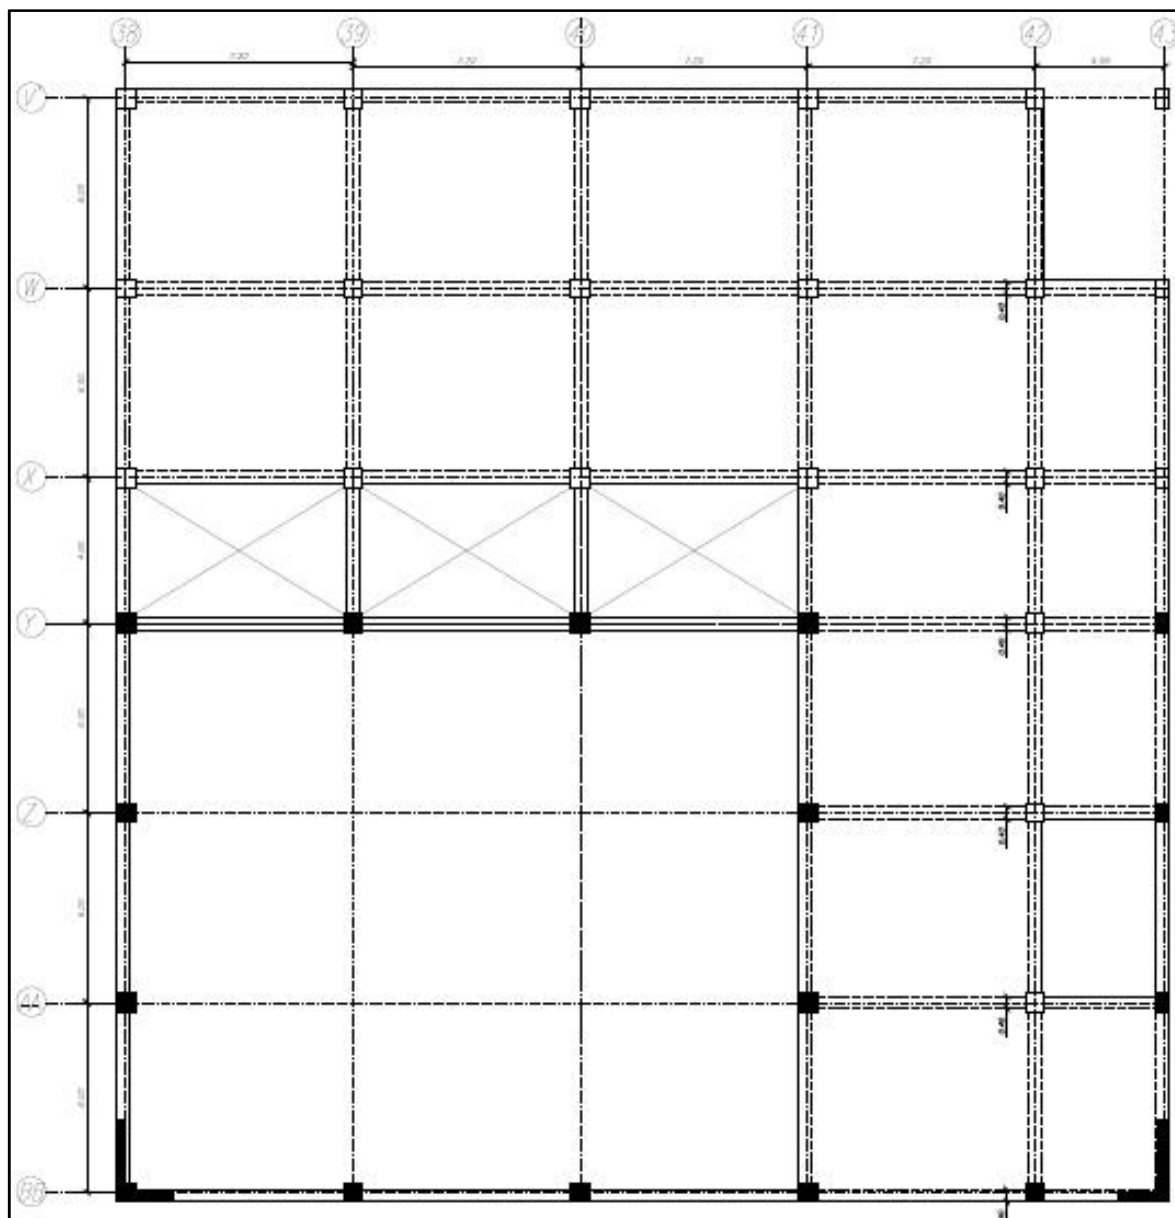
Planta estructural N+11.88, Consulta Externa II
